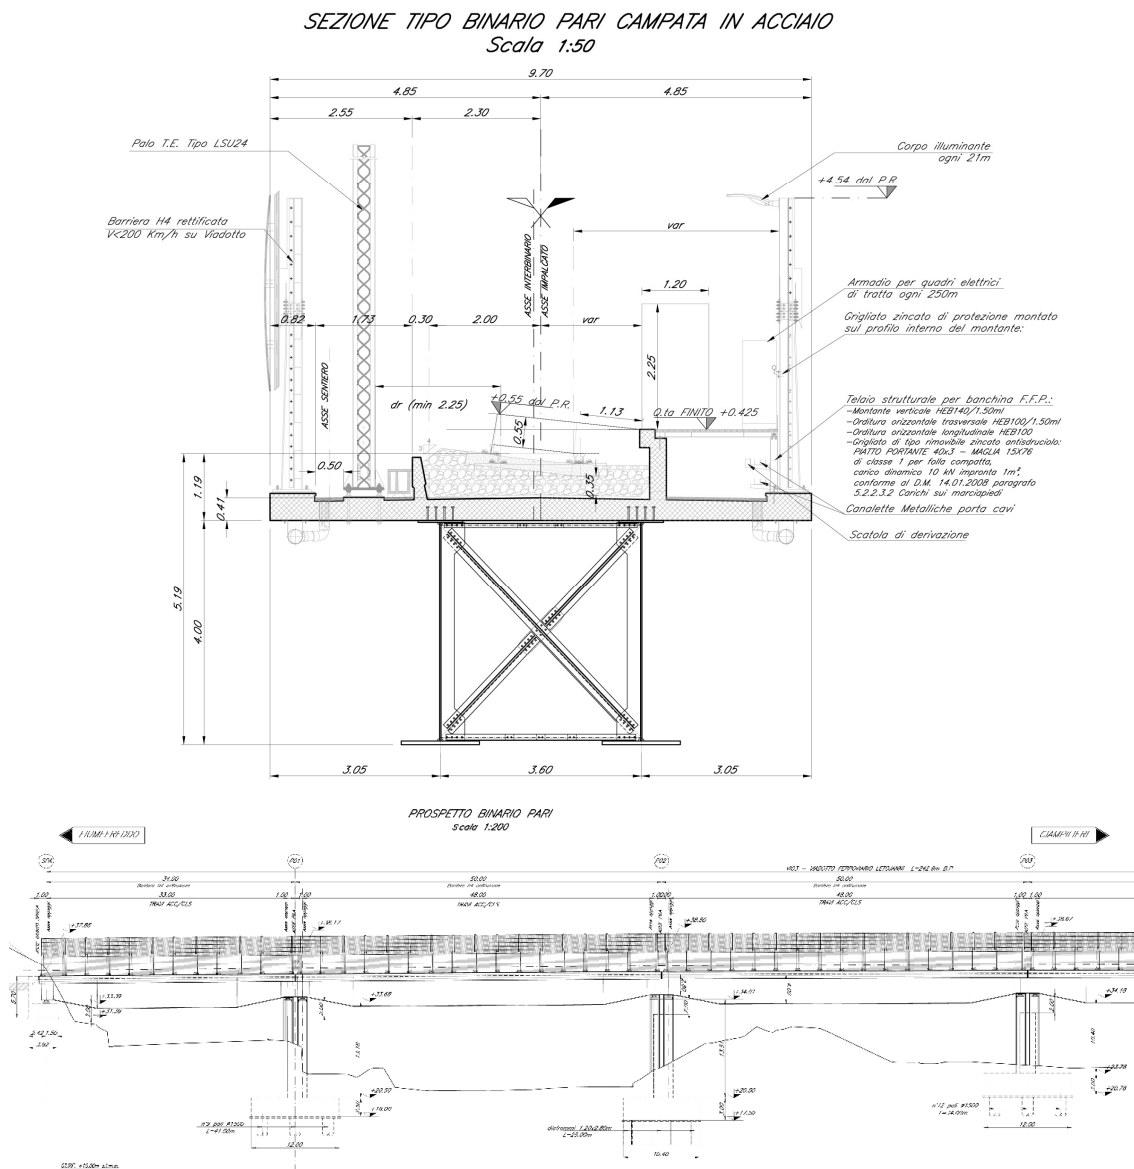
Viadotto Letojanni: sezione trasversale e prospetto binario pari
